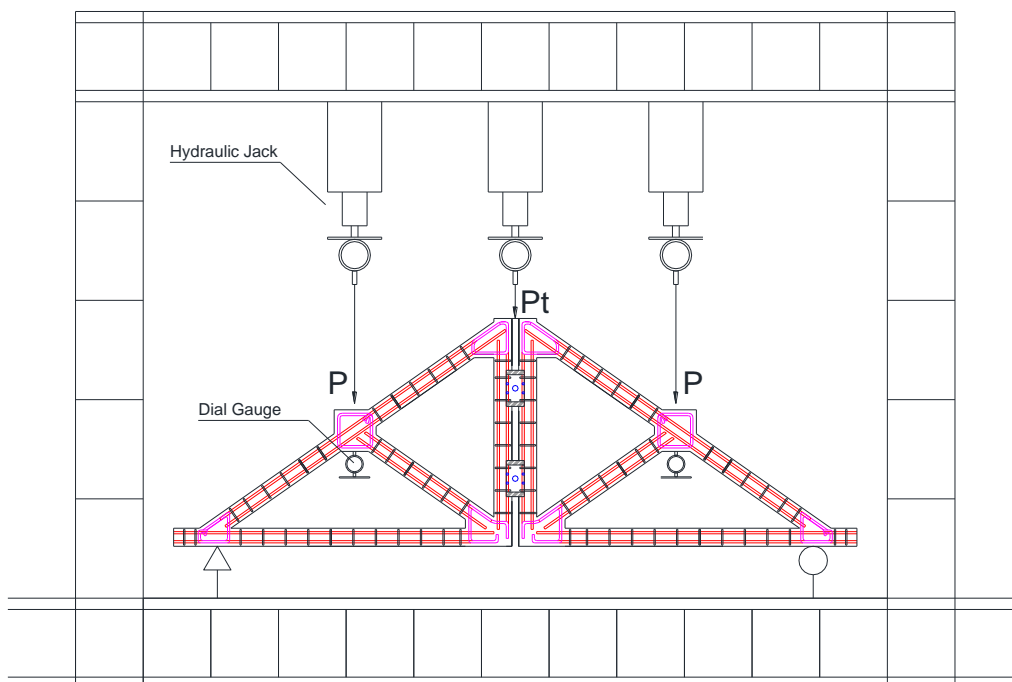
Desain kuda-kuda komposit beton bertulang bambu dengan sambungan cor grouting
